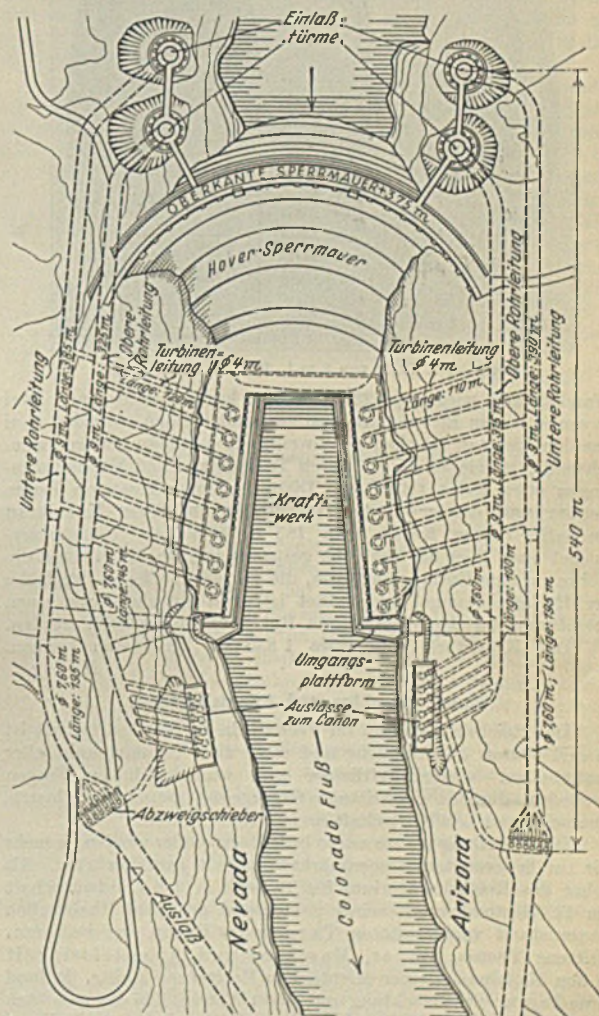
Grundriß der Sperrmaueranlage mit Rohrleitungen.
